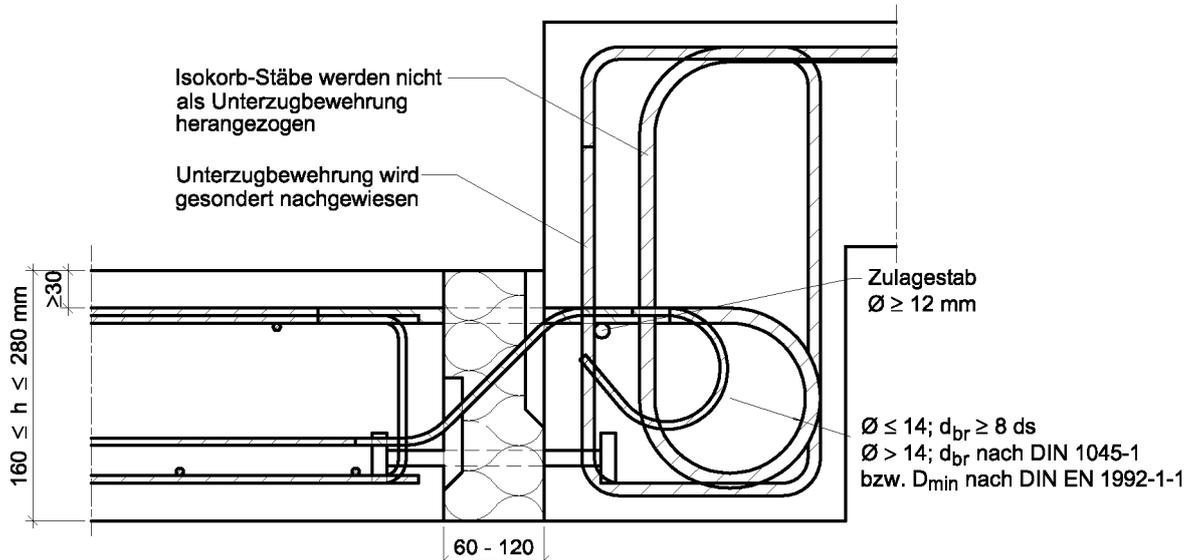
Beispiel Schöck Isokorb Typ KX (Variante Höhenversatz) mit Aufhängebewehrung (balkonseitig)
